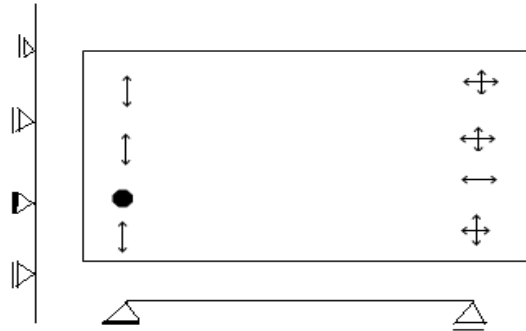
Modelo de sistema estático da superestrutura. Fonte (Autor)
